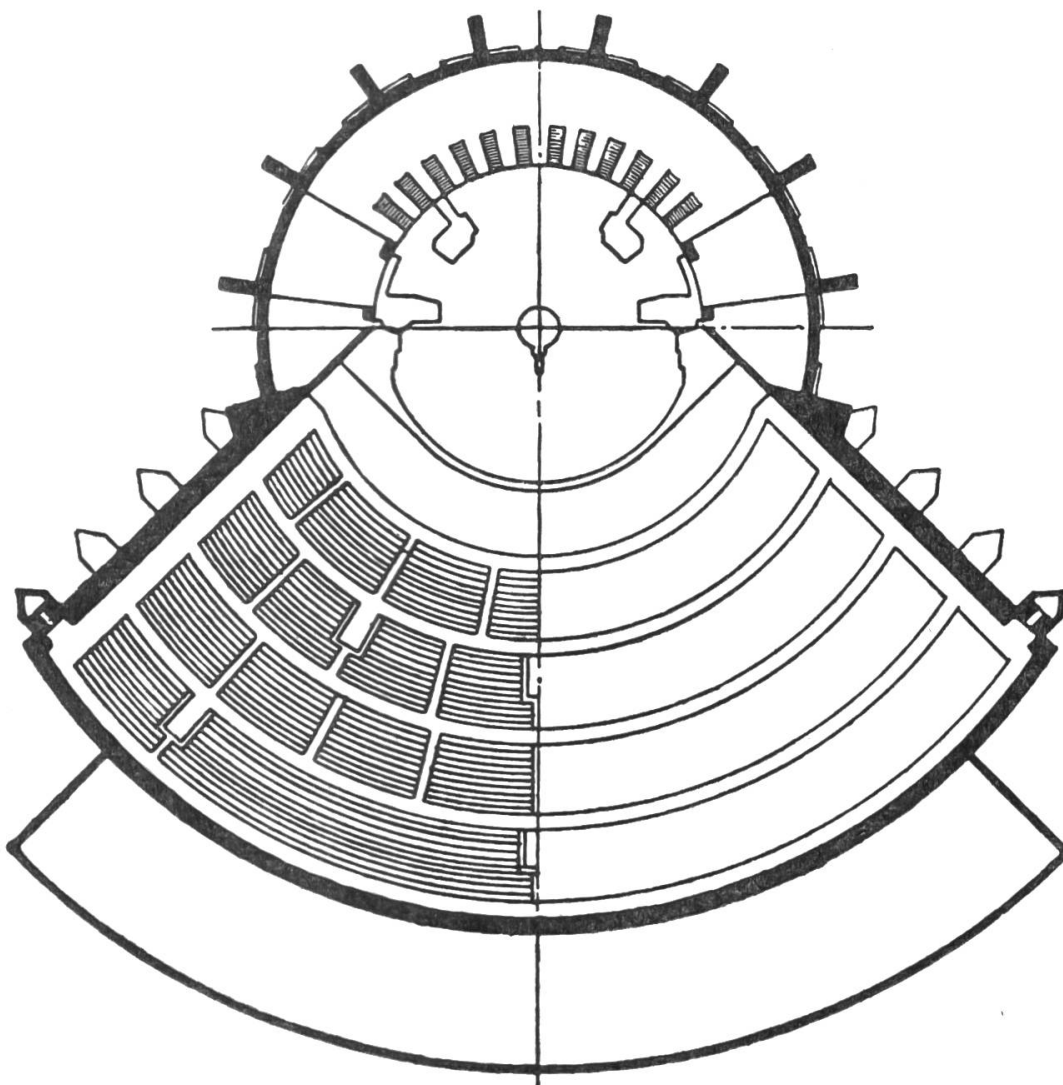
Theaterbau-Projekt N. Bel-Geddes. Grundriss.
